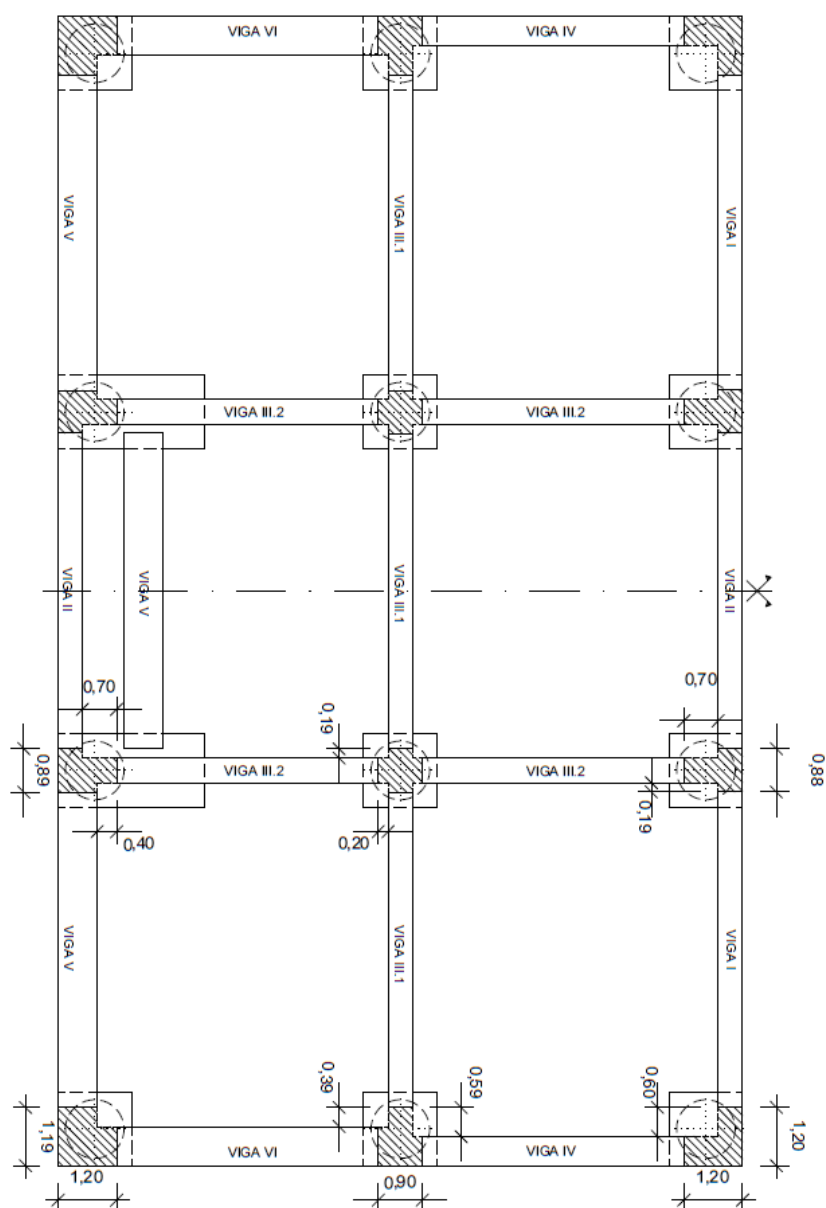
Situación de las esquinas hormigonadas en segunda puesta.
